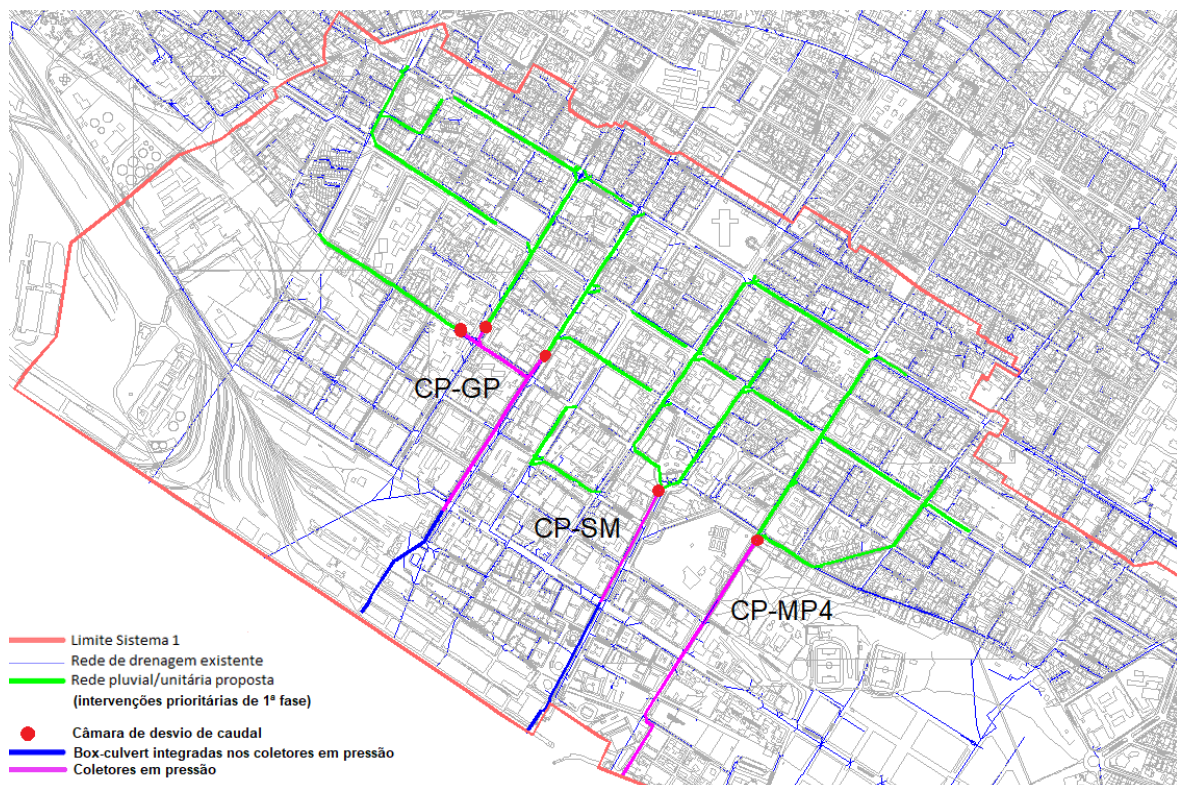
Planta esquemática ilustrativa do traçado dos novos colectores infra-estruturas associadas
